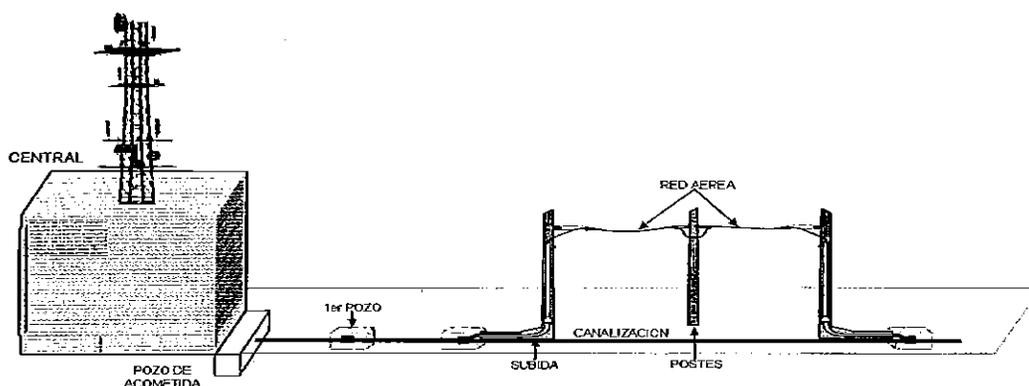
Edificio, Torre, y Obra Civil de Telnor.
